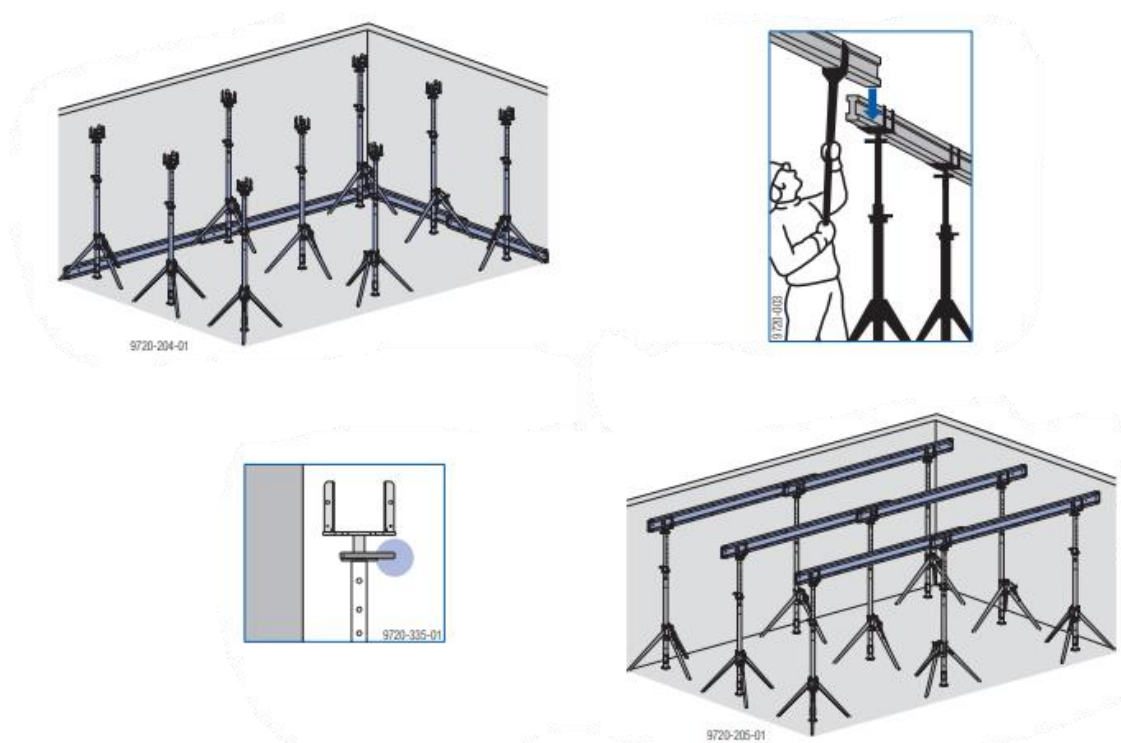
Schéma Stropního bednění Dokaflex 1-2-4 [8]
